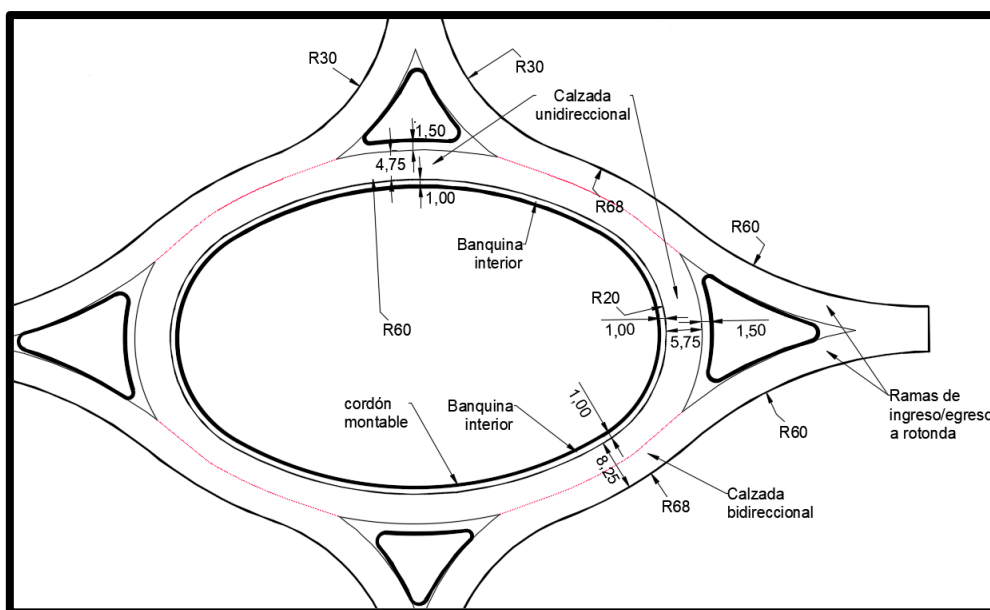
Planta tipo de rotonda. Fuente: Justo Domé & Asociados (2024).
